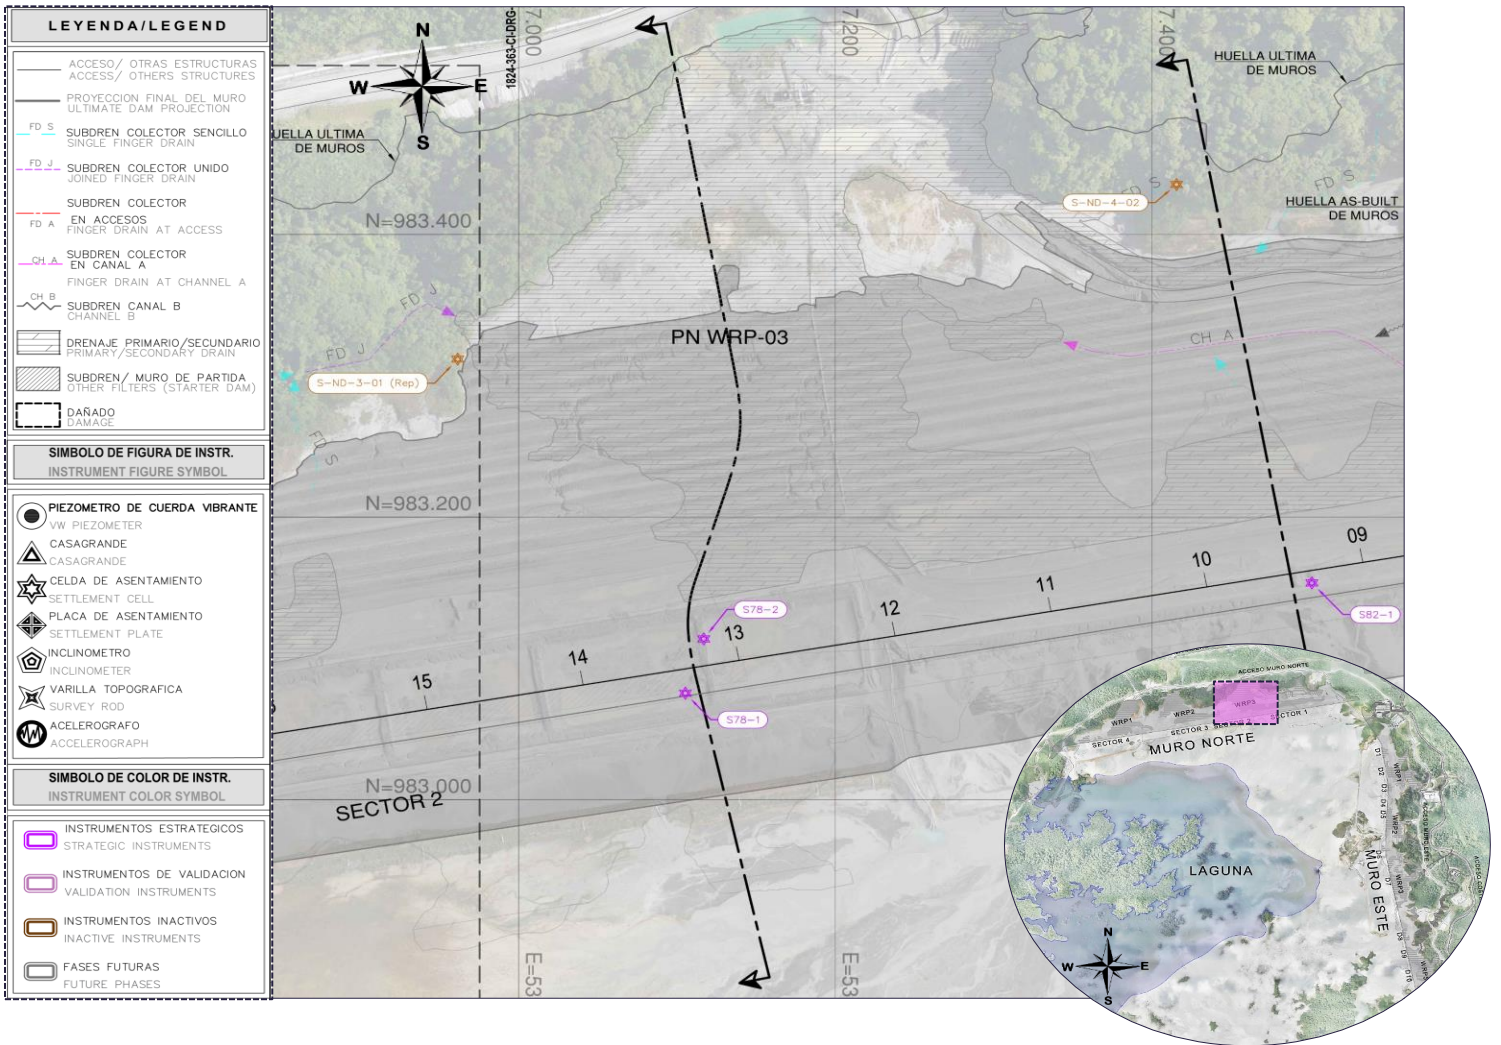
Vista de Planta en el Sector 1 - WRP3 con las Celdas de Asentamiento
